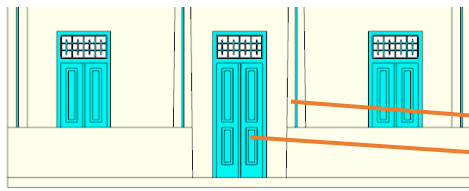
57 Dimensi pintu bangunan Desa Pamolokan
